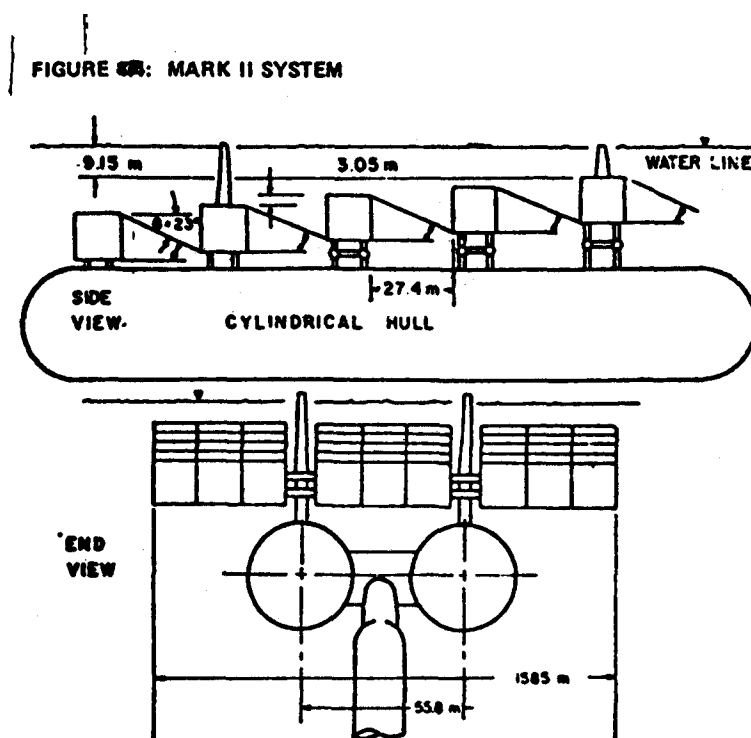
y 4.2.2. — Figuras de la planta UMASS, para dar una potencia de 400 Mw.
